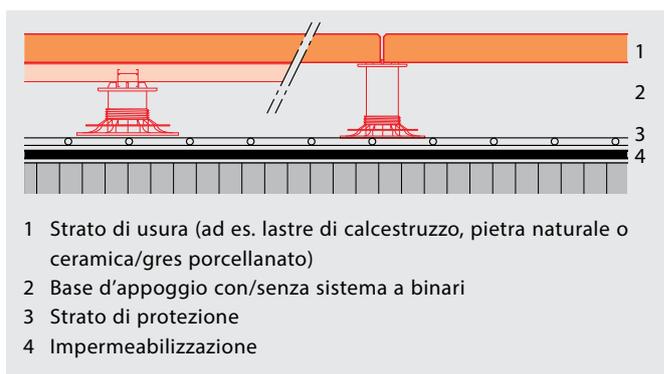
Struttura del sistema di uno strato di usura aperto su sistema portante aperto in struttura per tetto piano con isolamento termico.
